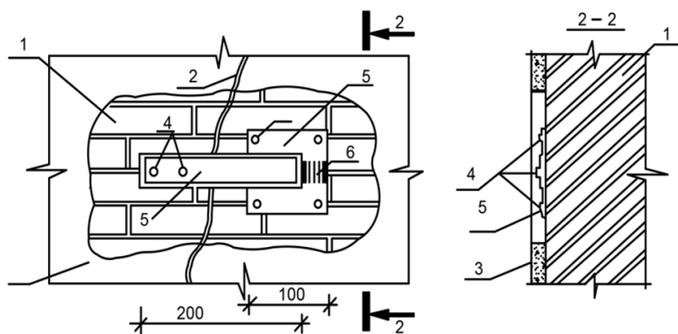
Металлический маяк: 1 – конструкция с развивающейся трещиной; 2 – трещина; 3 – штукатурка; 4 – гвозди; 5 – металлический маяк (из кровельной стали); 6 – риски через 1 мм
